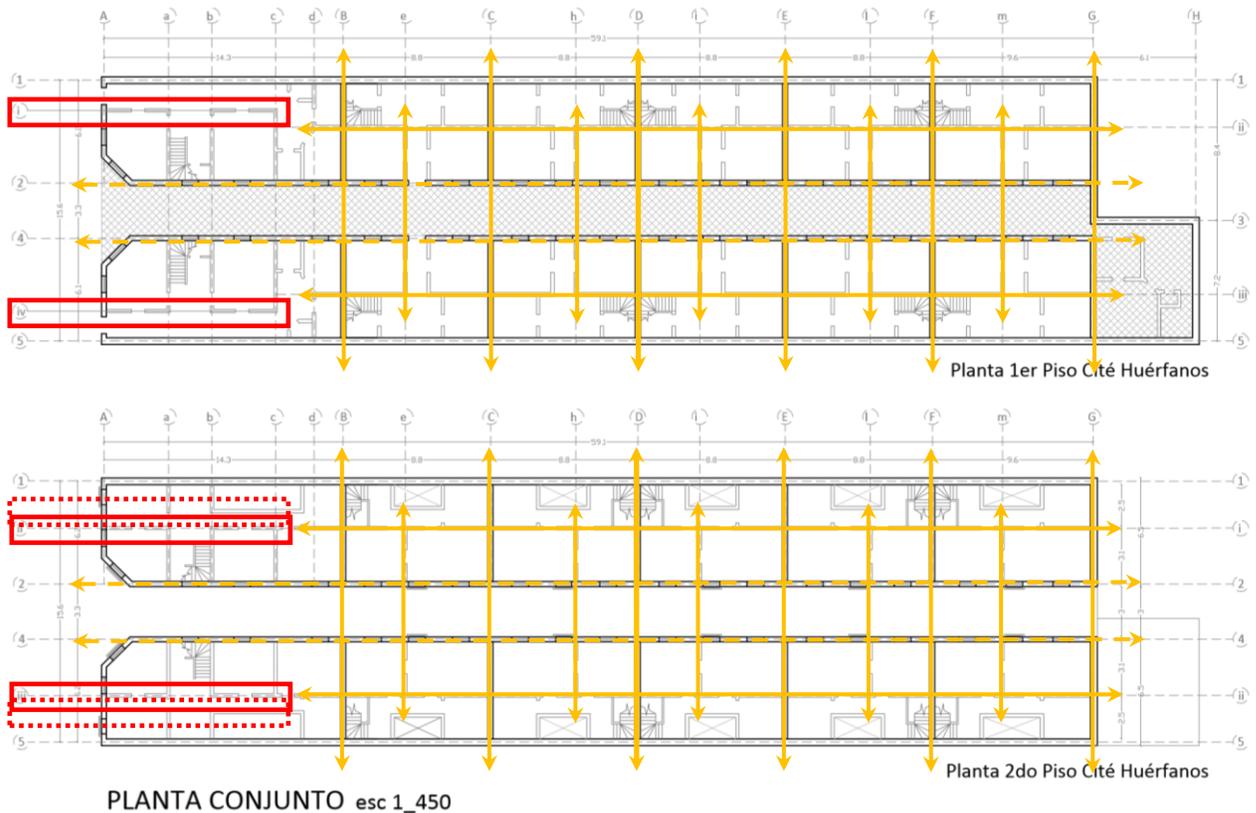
En la imagen se puede ver en un plano de planta de conjunto intervenida, aquellos ejes que traspasan sus cargas de manera directa a las fundaciones, estos ejes se demarcan con color naranja.
